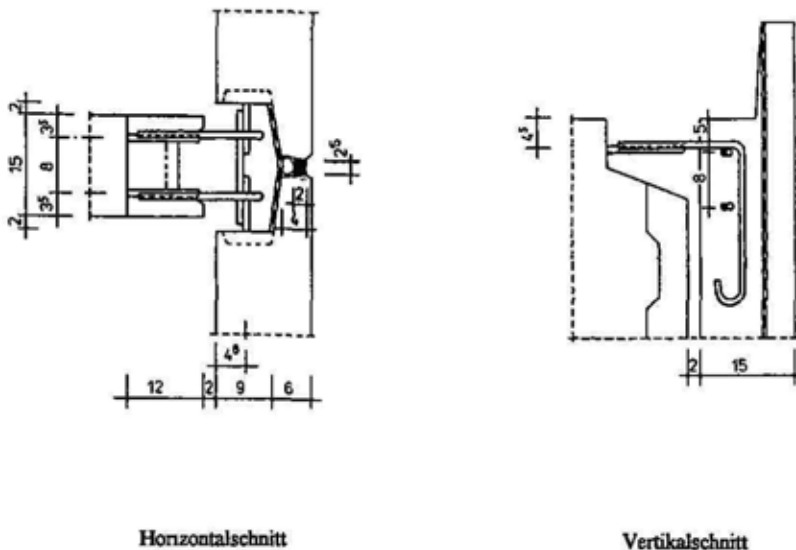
2.5 Verbindungsdetail Kelleraußenwand - Kellerinnenwand
